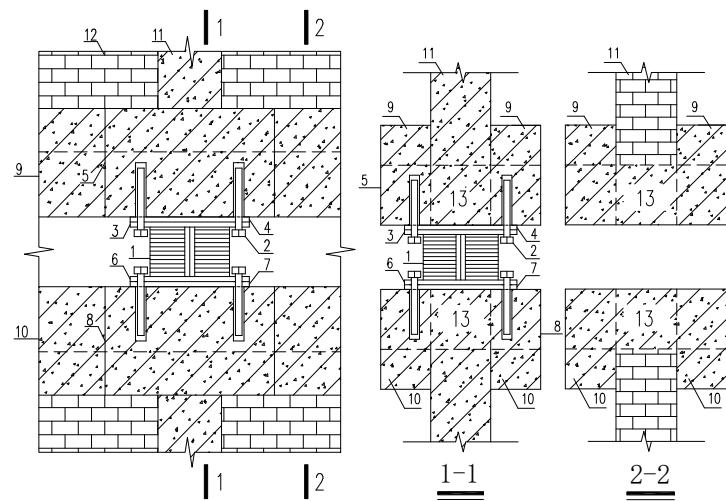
双夹梁构造柱托换及隔震支座安装示意图
